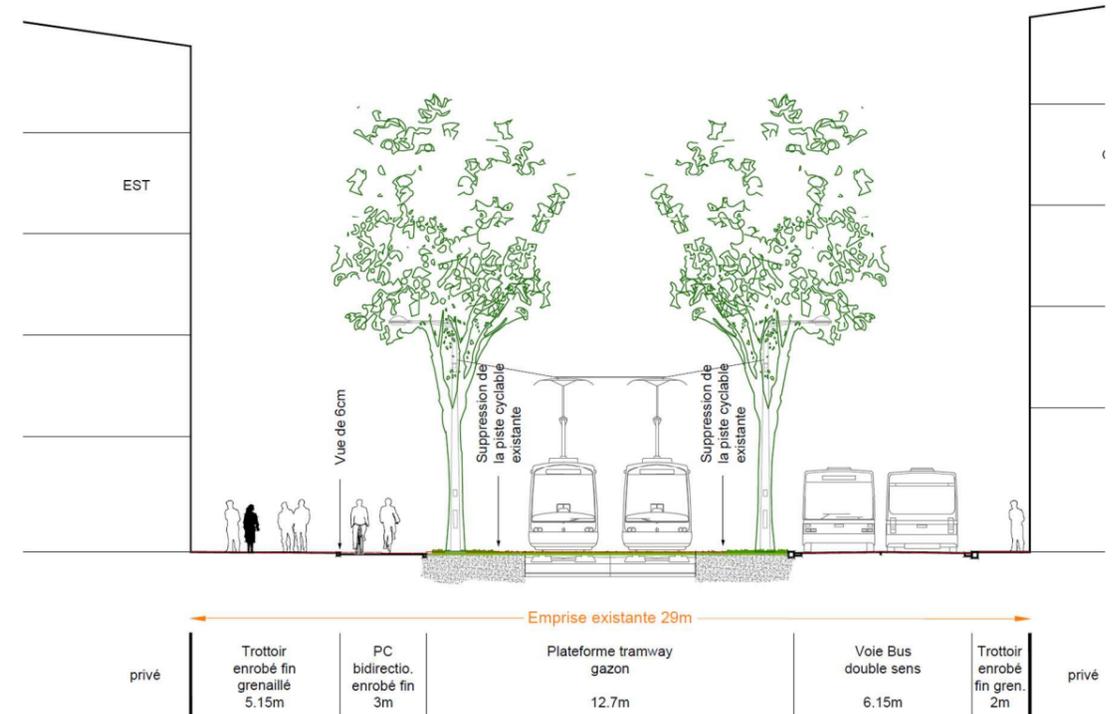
Coupe du boulevard Wilson sur la section entre Place de la gare et Fbg de Saverne (source : AVP GETAS, 2023)
